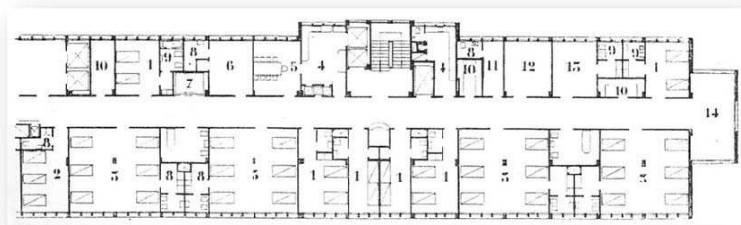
Planta del Hospital Churrucá. (Revista Arquitectura de Hoy, 1947: 50)
